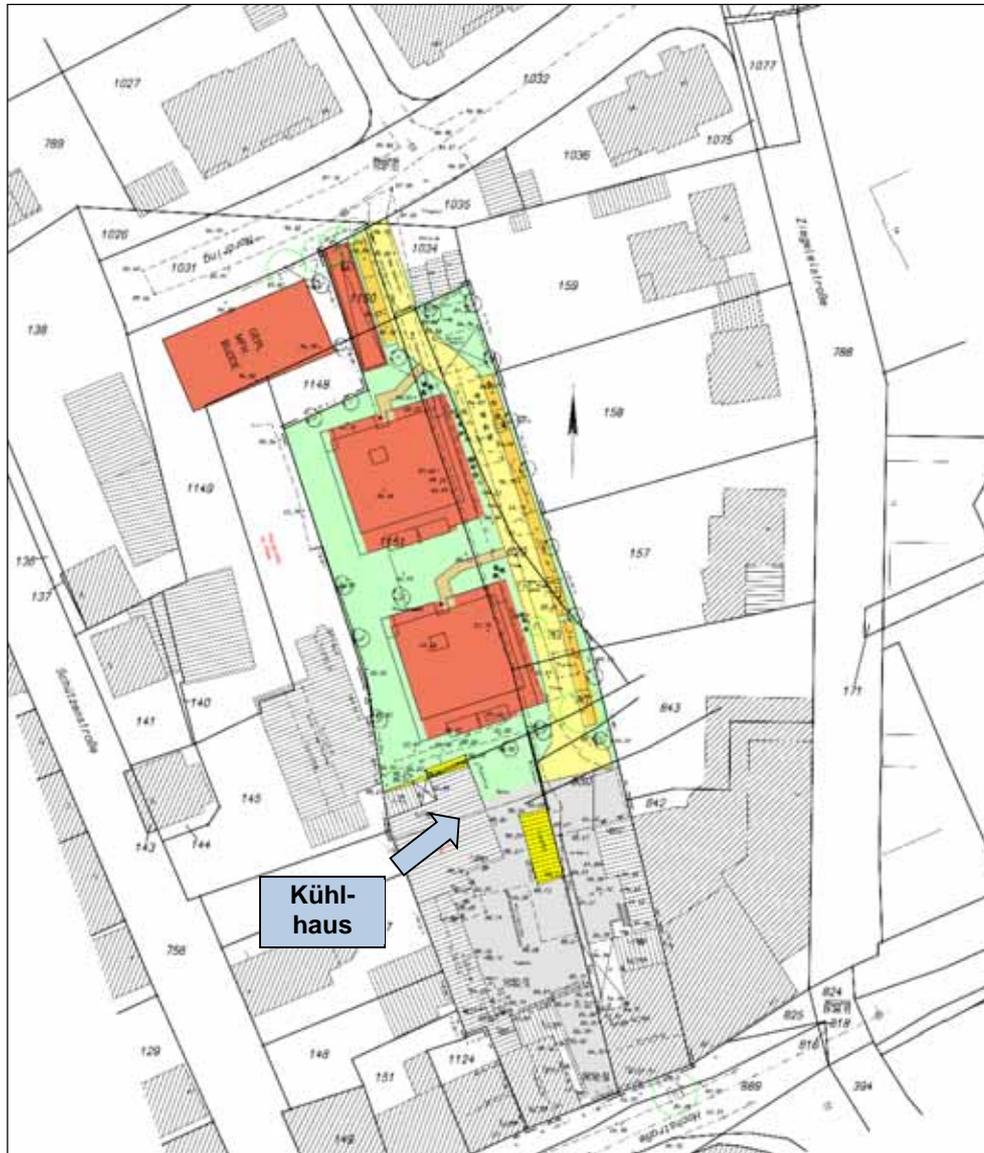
Lageplan zum Vorhaben (Ausschnitt) /9/
